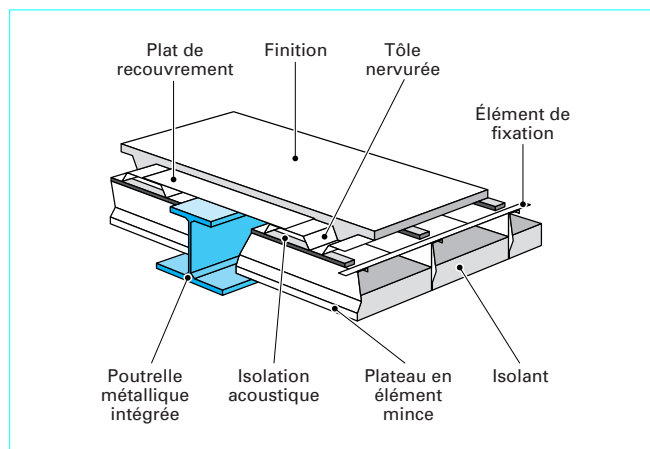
Plancher sec. Système IDES de VAN DAM BV
